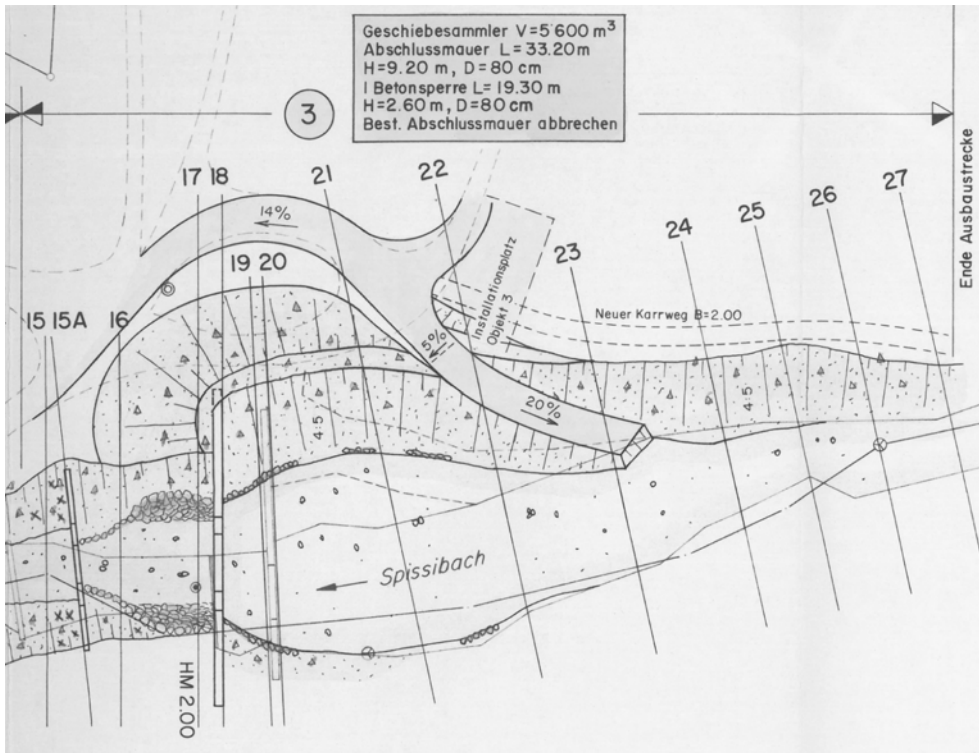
Grundriss Bereich Geschiebesammler Spissibach mit Auslaufbauwerk bei Profil 18 (aus Spissibach, 1996).
